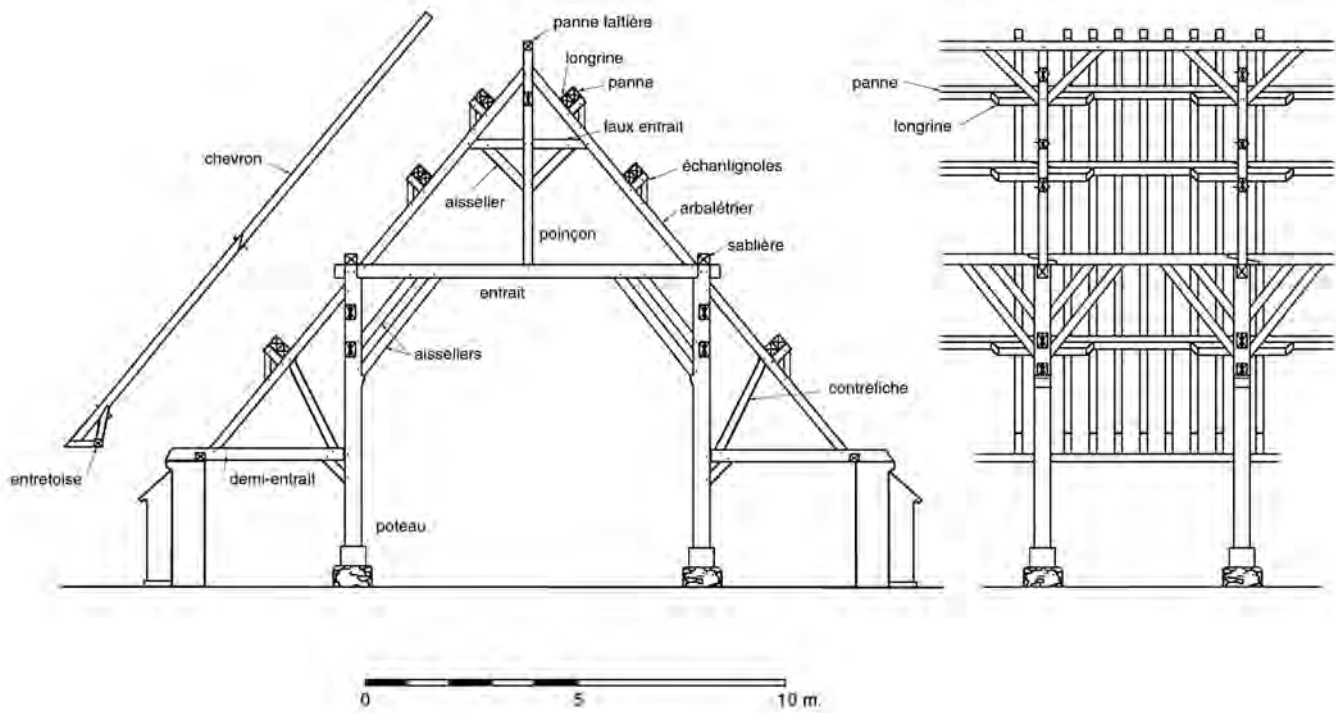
Ferme sur poteaux et coupe longitudinale d'une travée (1237-1243d).
